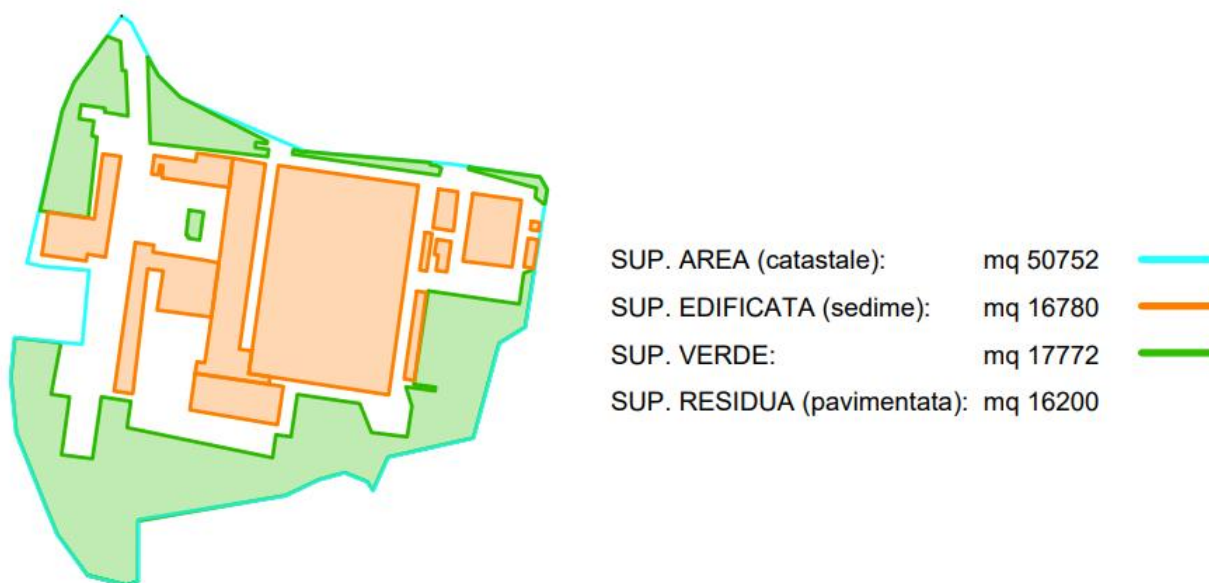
Planimetria del complesso immobiliare di Pentima, con individuazione delle aree.
